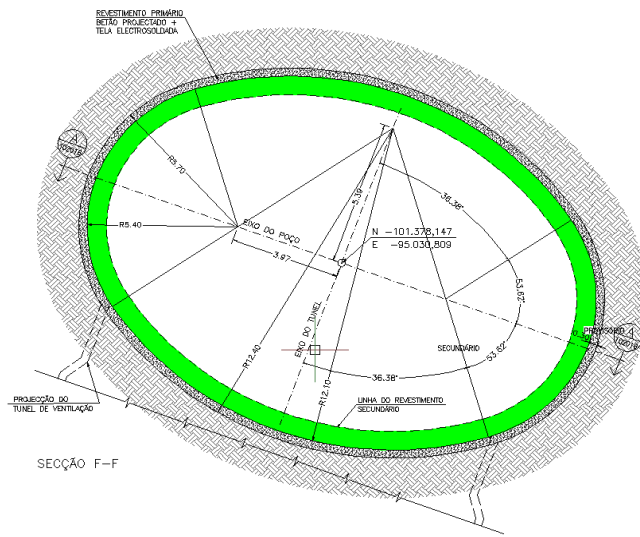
Planta do poço de ventilação de secção elíptica (adaptado CIC, 2009).
